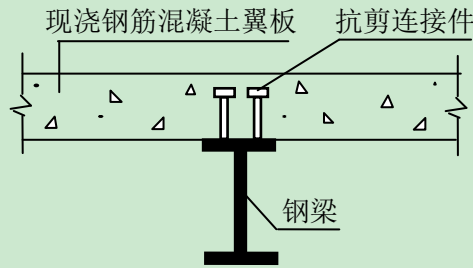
现浇钢筋混凝土翼板组合梁剖面
